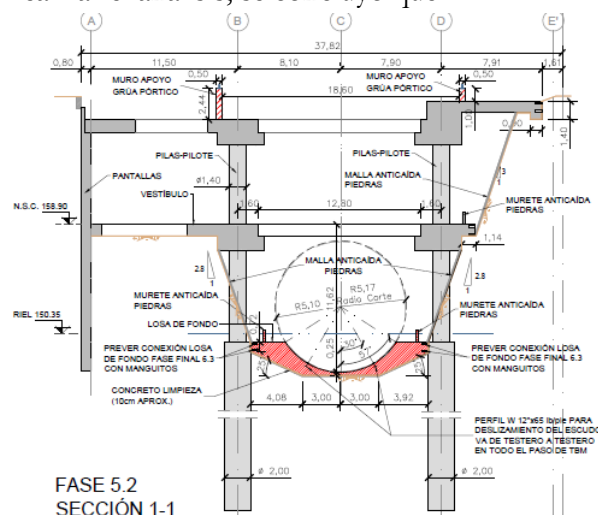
Sección tipo Estación con ejes B y D de Pilas principales analizadas.
